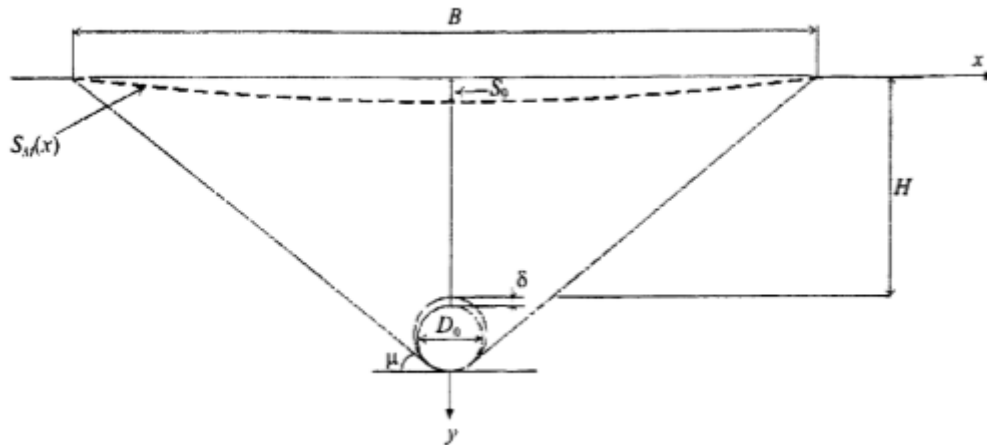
Пример расчетной схемы деформирования основания над подземной тоннельной выработкой
